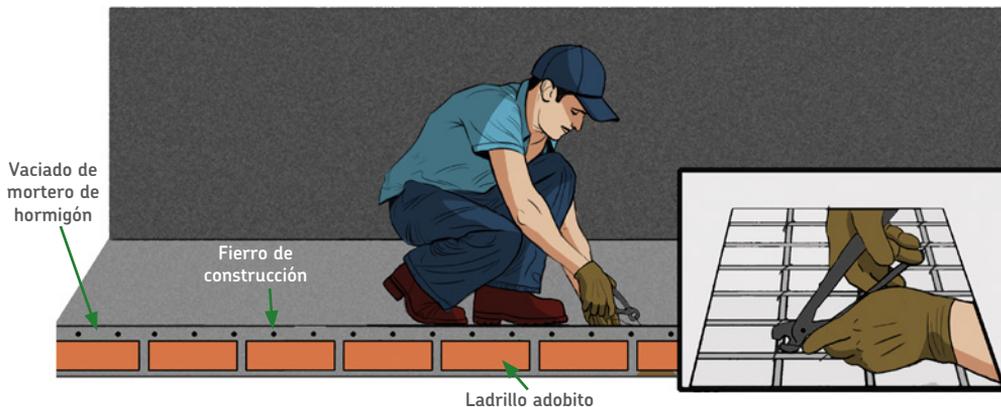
Preparación del emparrillado con fierro de construcción para la base del tanque séptico.
